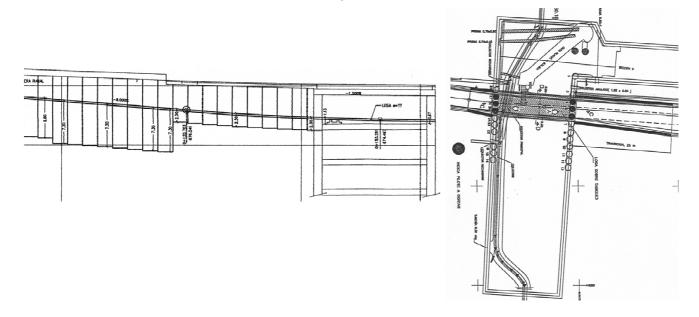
Alzado y planta de la actuación en el Telescopio existente de la intersección de las calles de María de Molina con Velázquez
